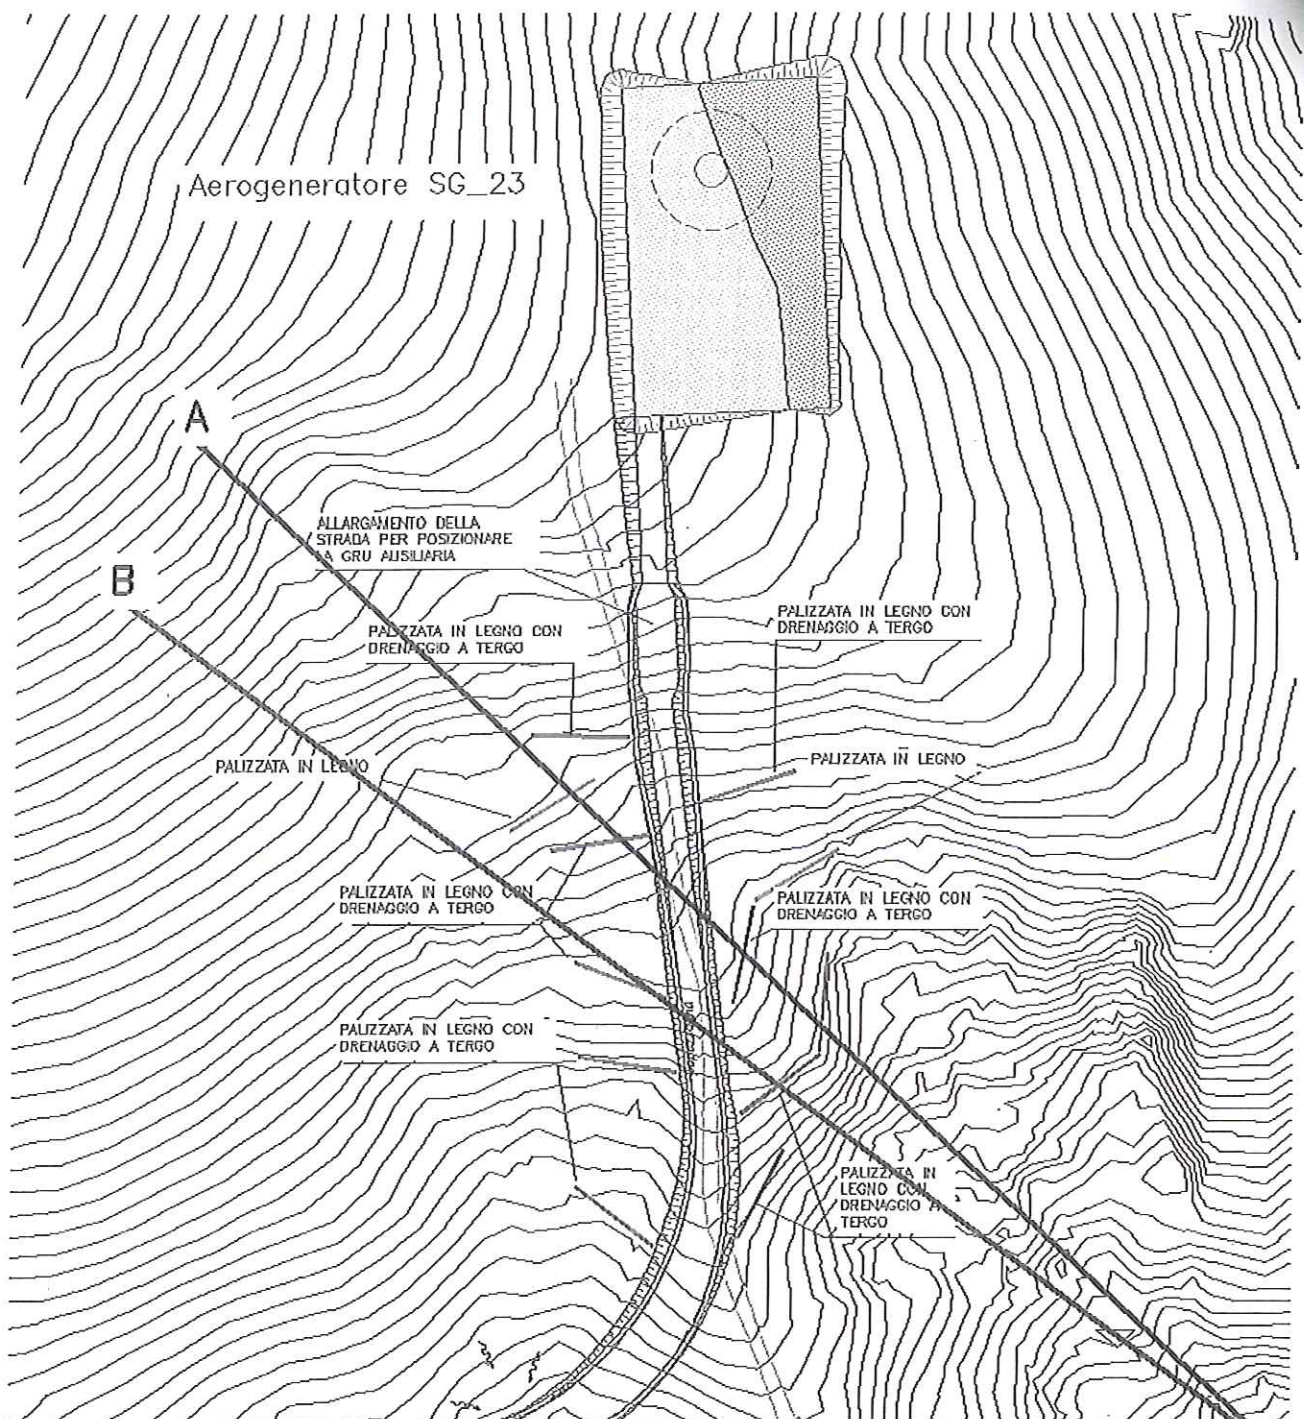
Ubicazione planimetrica delle palizzate di protezione
